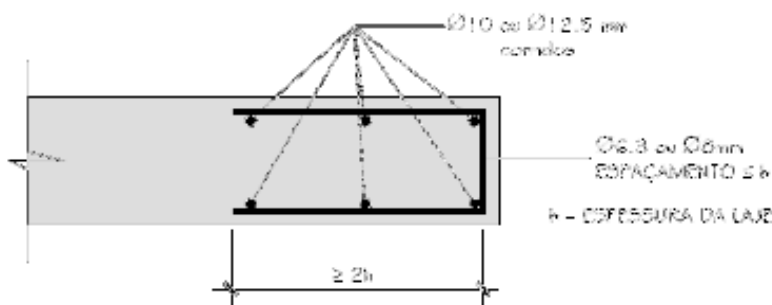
Armadura de reforço da borda da laje - Fonte: EMERICK
